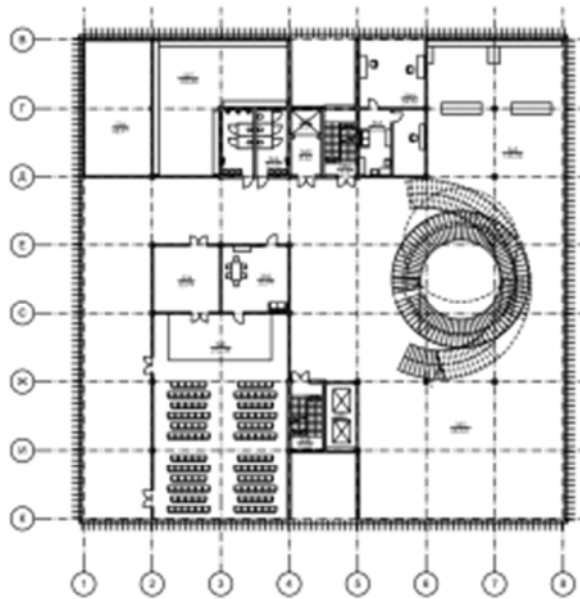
План 5-го поверху на відмітці 20.400 м
